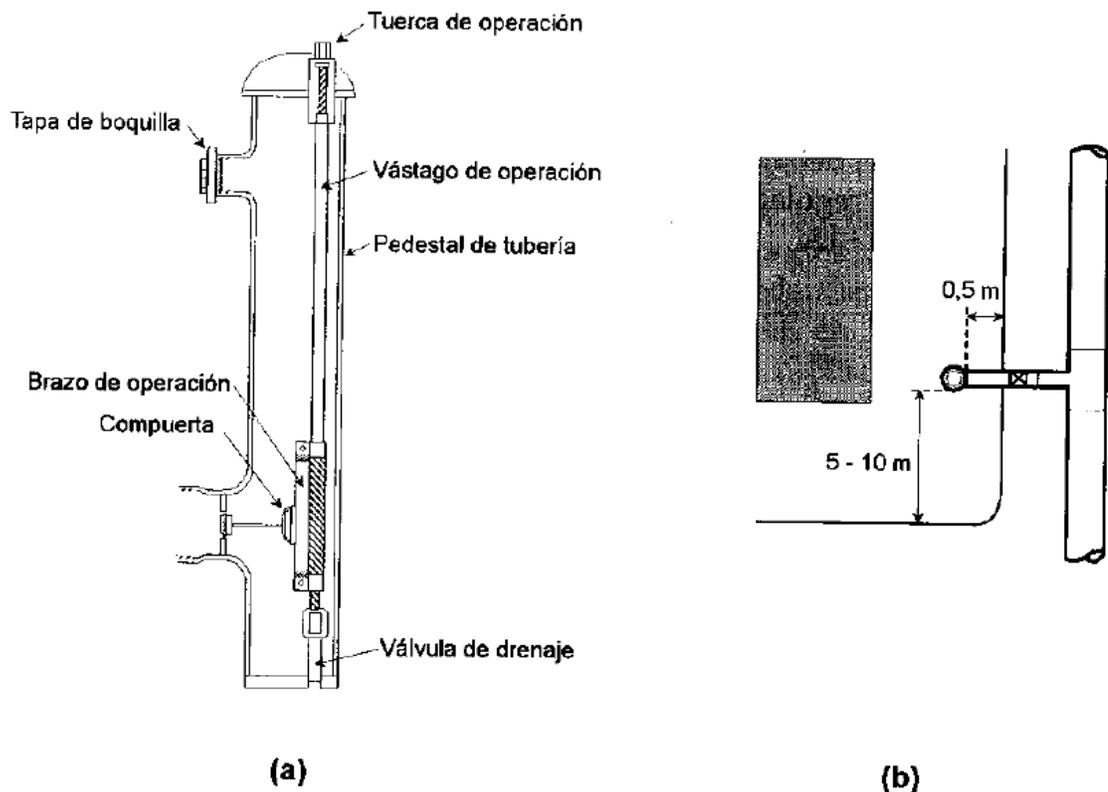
(a) Detalle del Hidrante (b) Localización del Hidrante.
